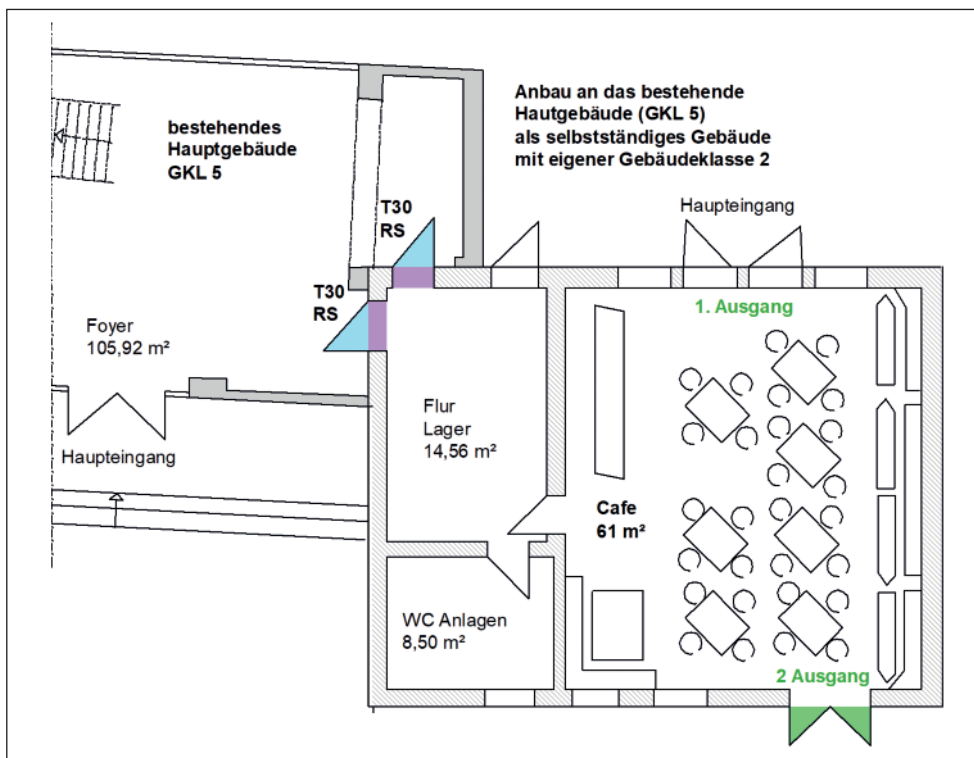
Anbau eines Cafés an ein bestehendes Hauptgebäude (Grundriss)
